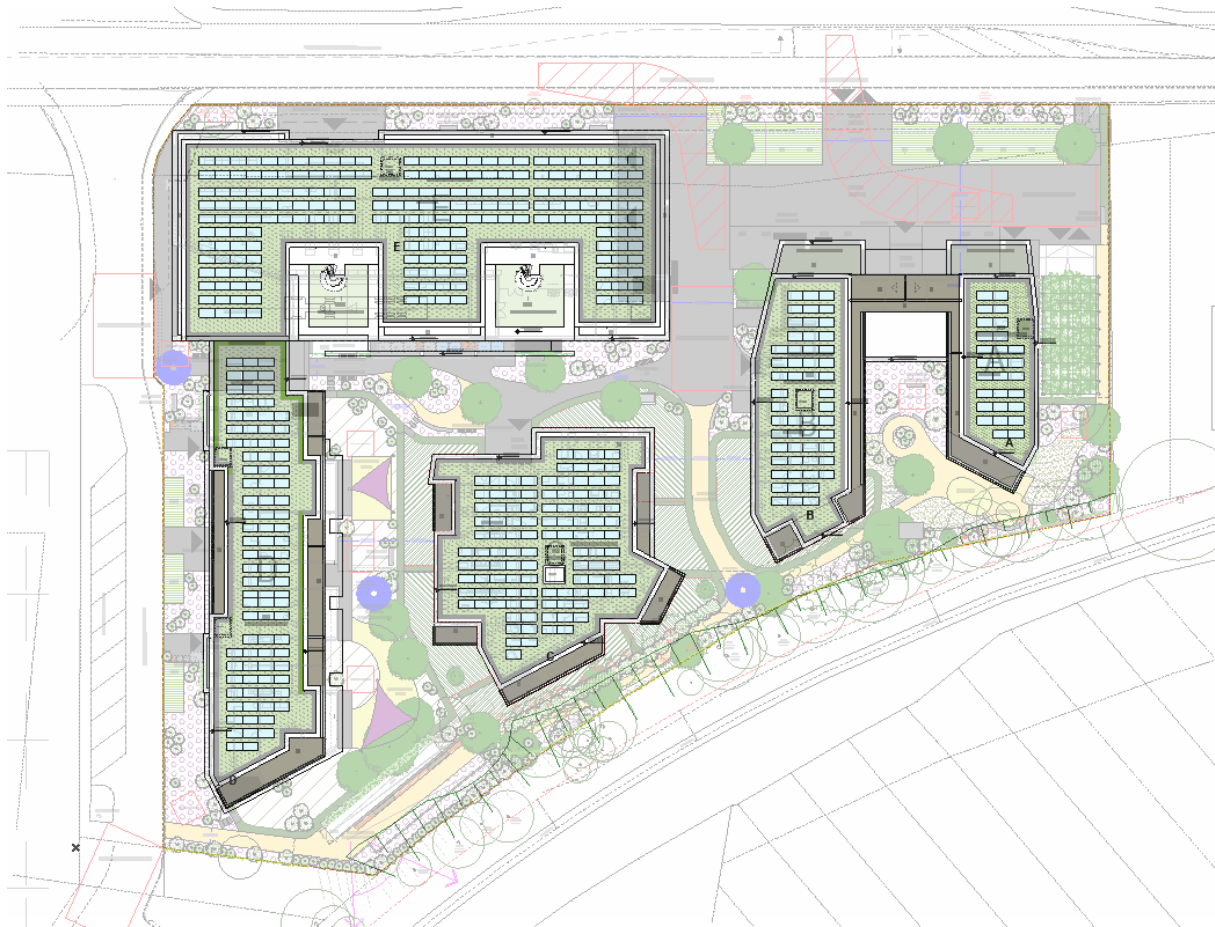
Dachaufsicht Vorhabenplan, Stand Oktober 2023, Quelle: planquadrat
